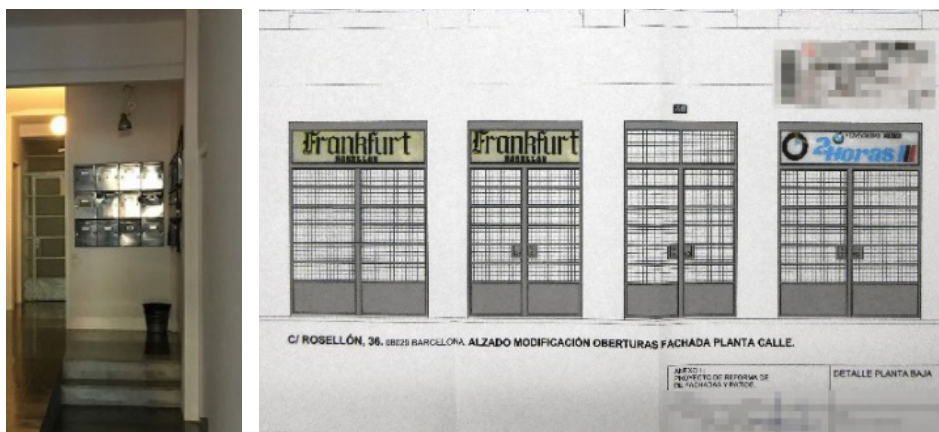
Derecha, puerta dentro del portal, posiblemente original del proyecto, Izquierda, plano de carpintería inspirada posiblemente en la existente. De Ángel Castrel, Daniel. Plano 5. Expediente 02.2007L02734 Memoria del proyecto. Arxiu Municipal del Eixample
